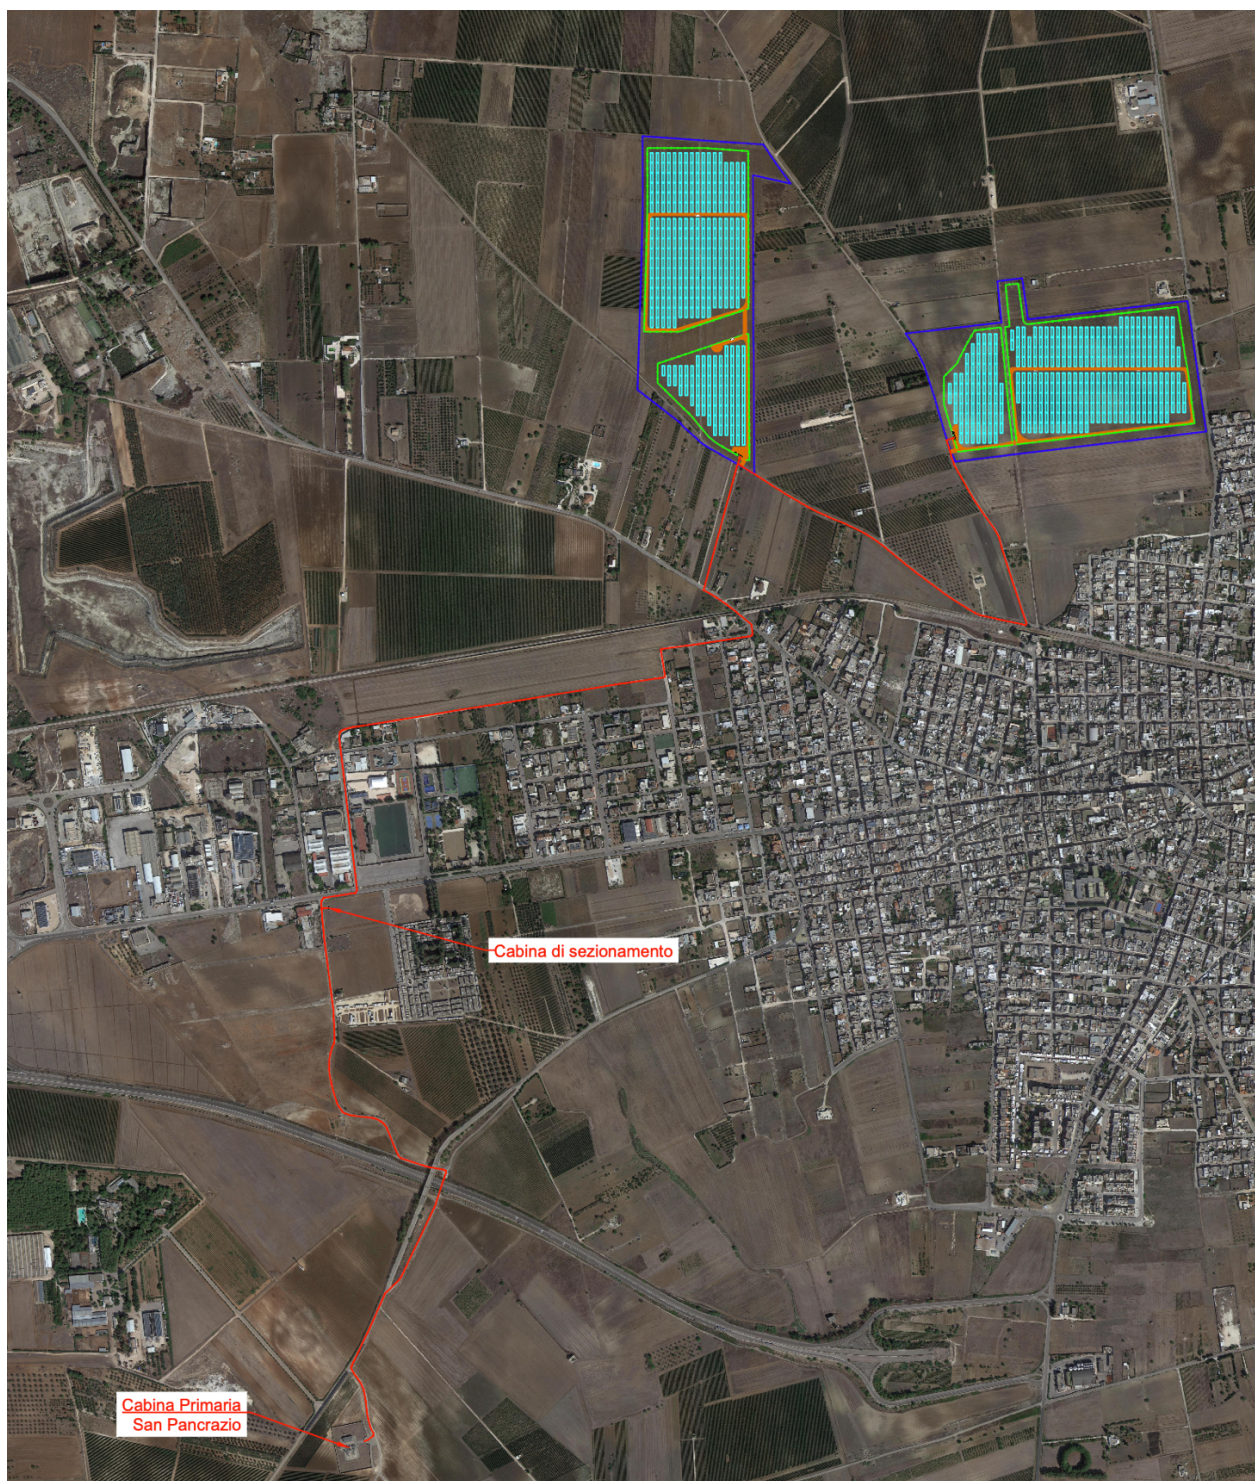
Sito di intervento dell'impianto con indicazione (in rosso) del tracciato di cavidotto, posizione della Cabina di Sezionamento e della Cabina Primaria "San Pancrazio"
